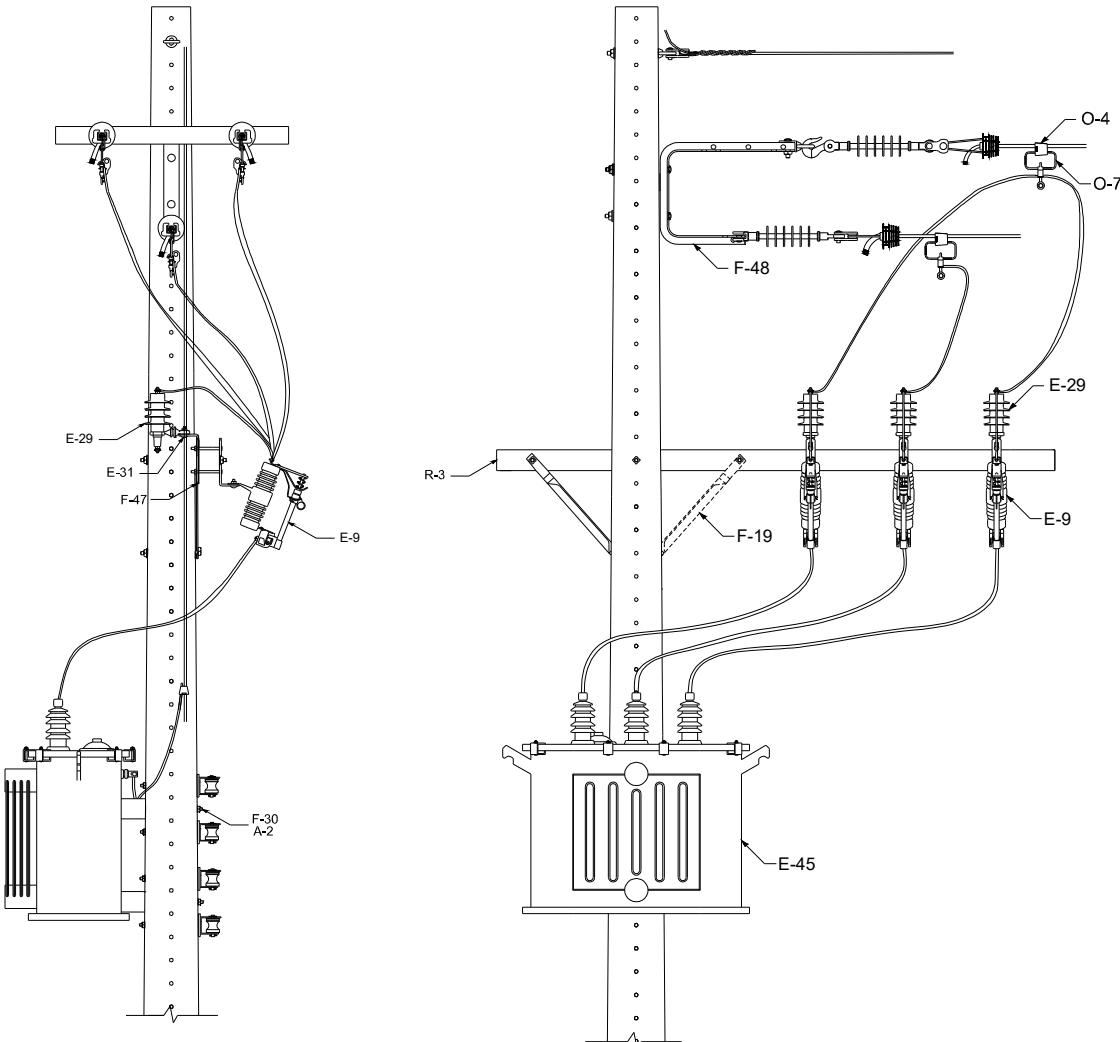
Instalação de equipamento – Transformador trifásico – Chave fusível e para-raios no suporte horizontal – Estrutura C3
